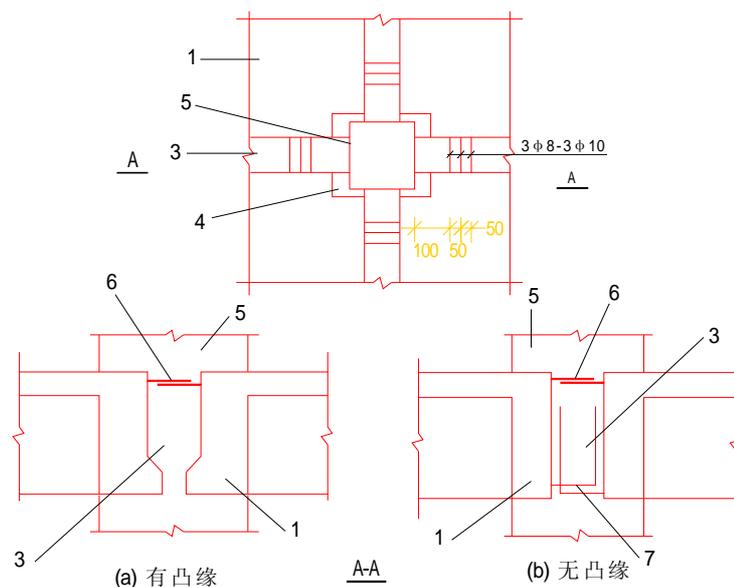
板柱节点相邻板角、边梁梁端之间连接钢筋
